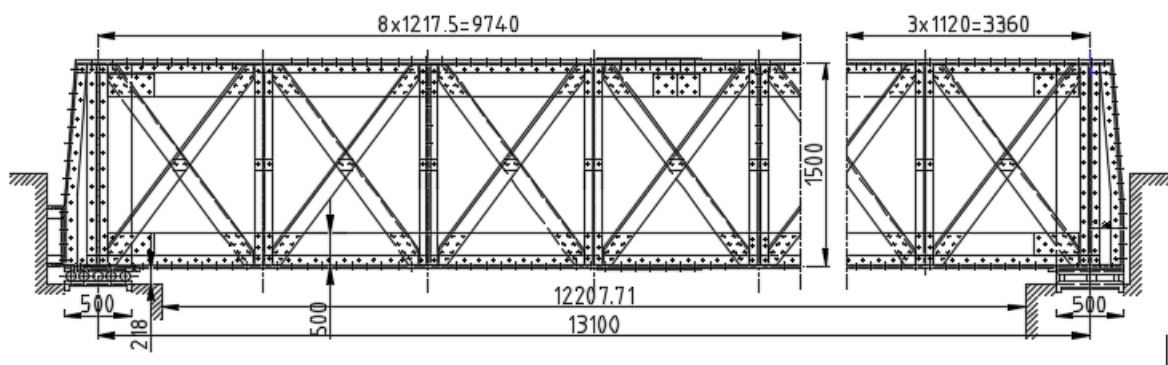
Vue en élévation de la poutre en treillis du pont PK 107+373
